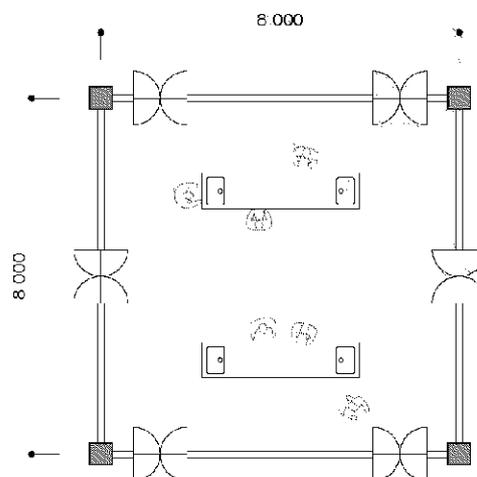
(16) Plan de la zone de traitement de poissons frais
